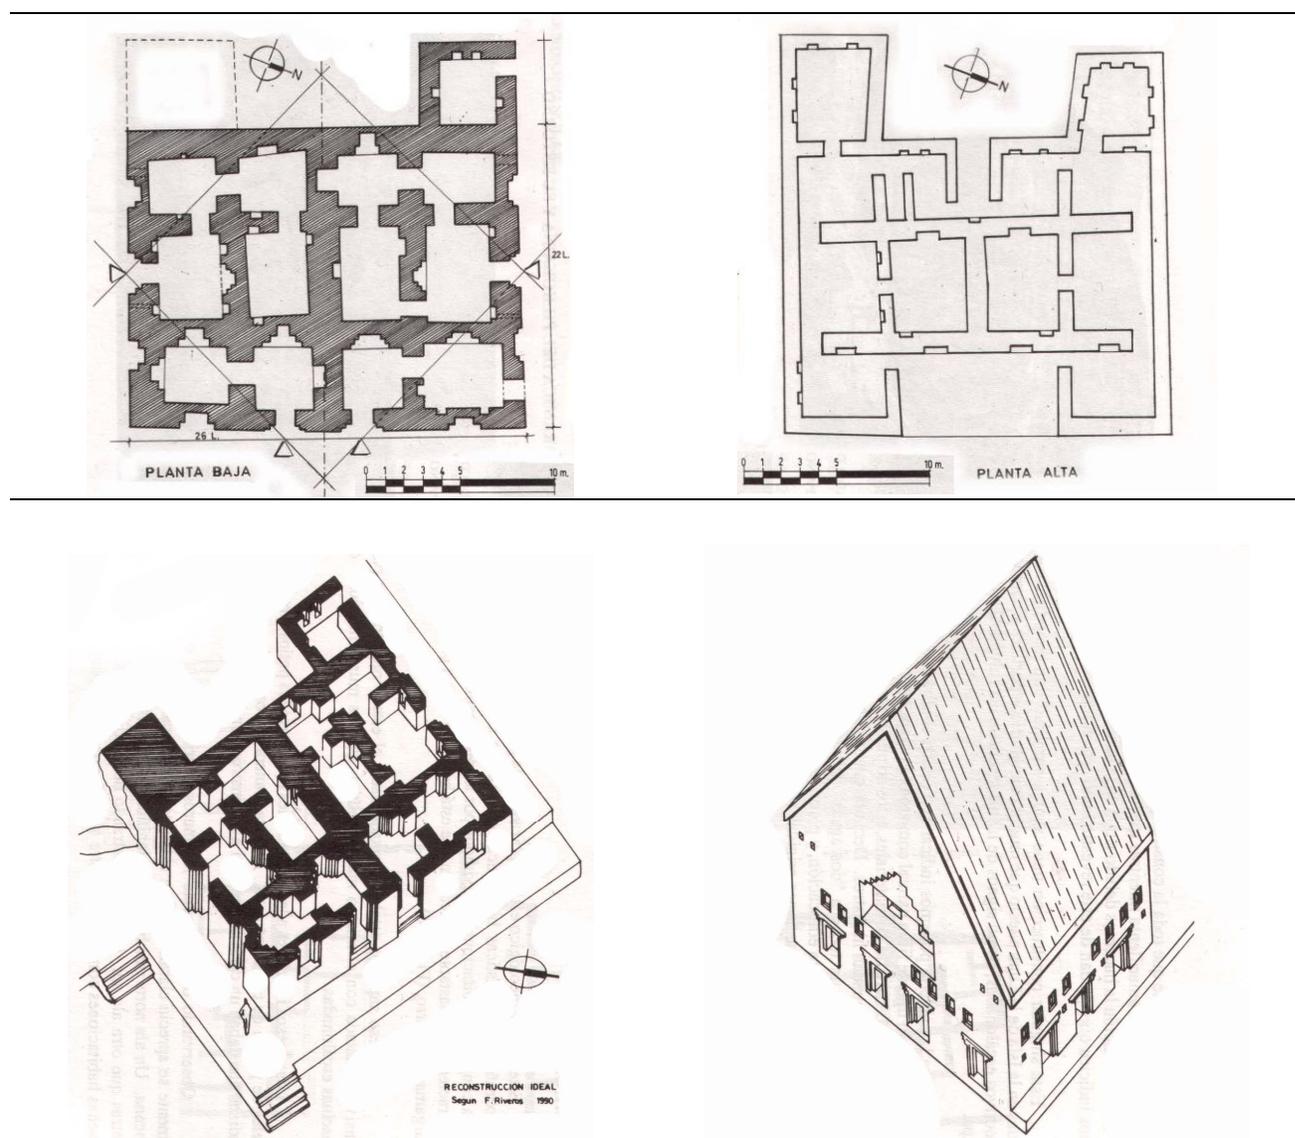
Palácio Inca de dois pavimentos, Pilkokaina
